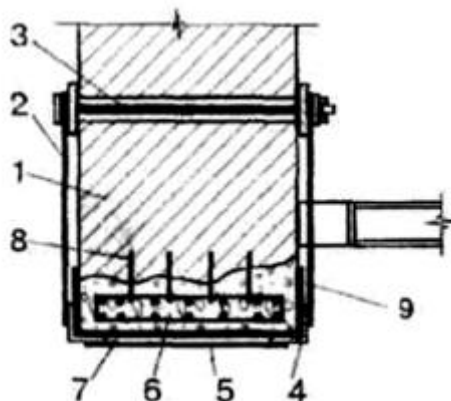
Схема підсилення кам'яної конструкції металевою обоймою;
